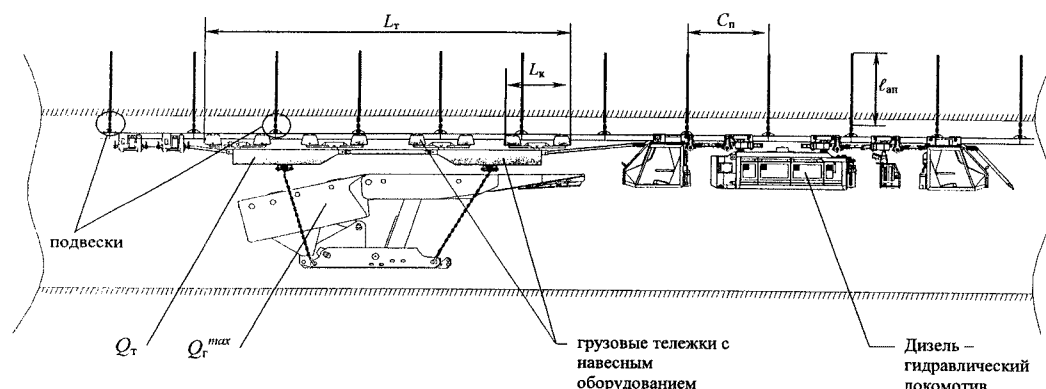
Схема к расчету нагрузок на подвески ПМД
